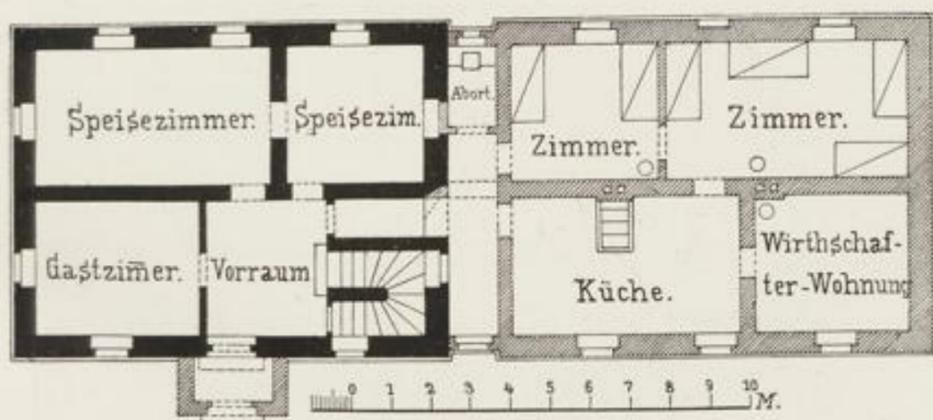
Grundriss vom Erdgeschoss.
